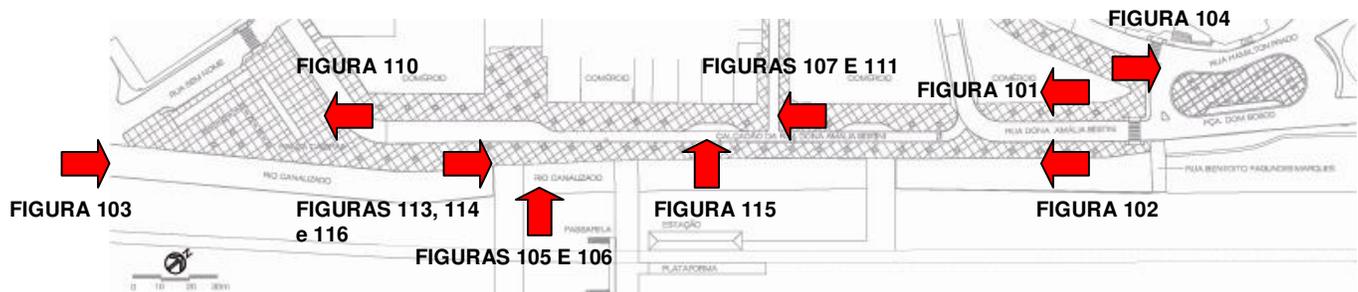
Planta da Estação de Franco da Rocha com a indicação das fotos
